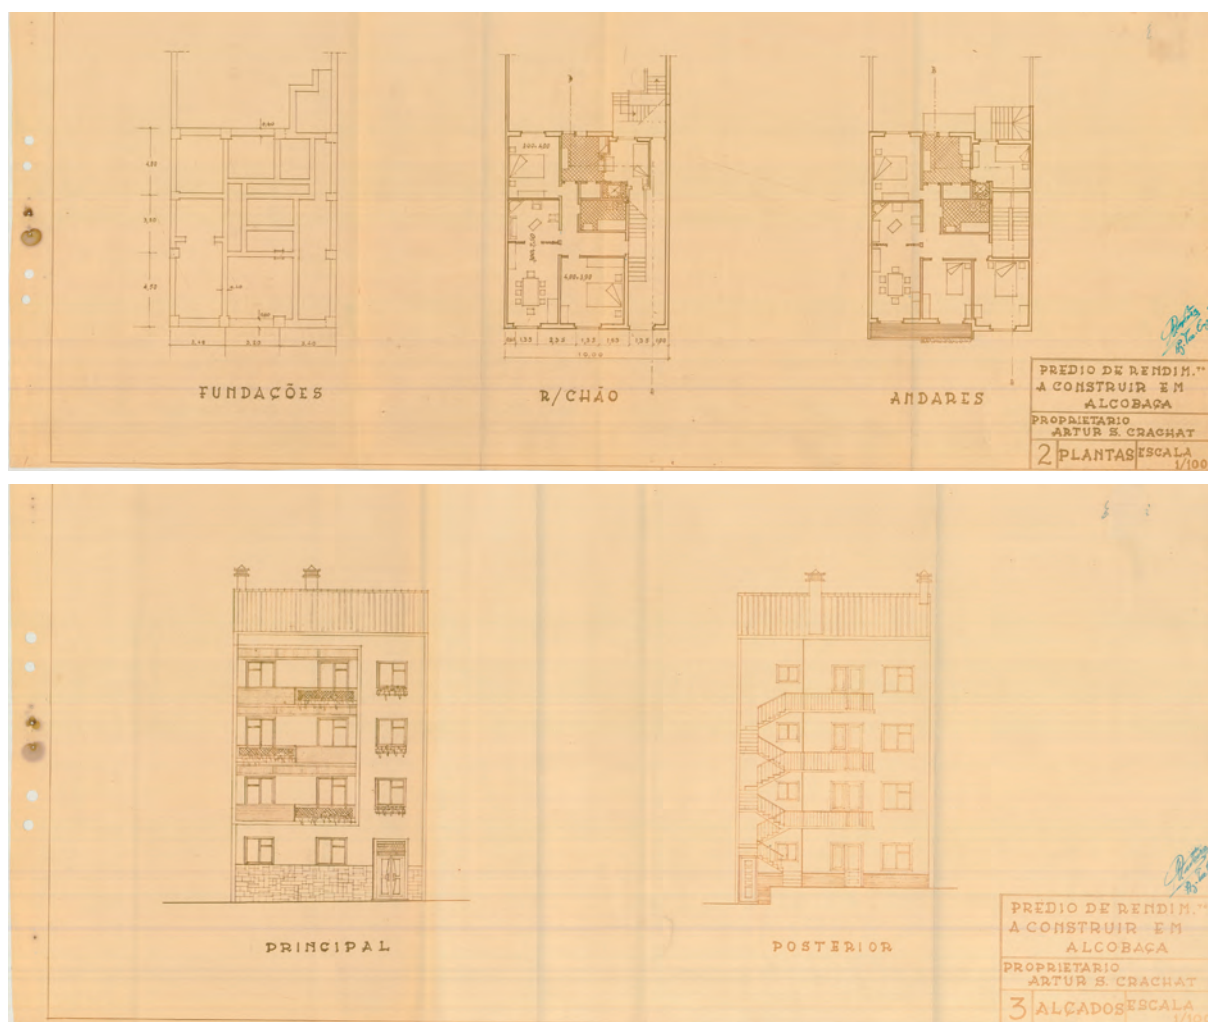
Processo de Obras nº 263/61 – Plantas e Alçados.
